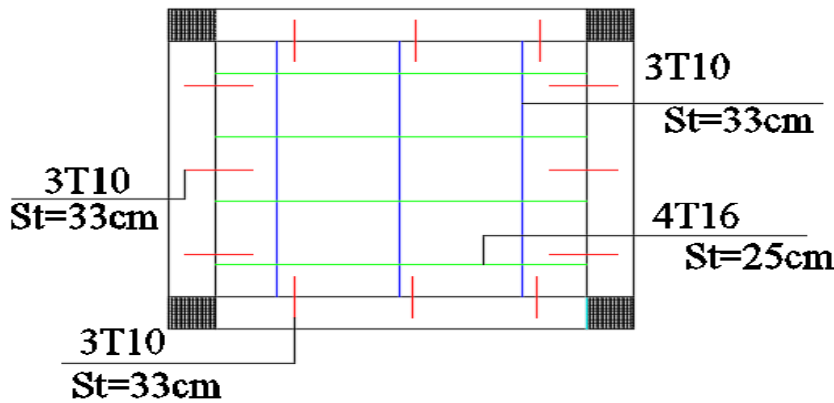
schéma de ferrailage de dalle pleine en 4 appuis
